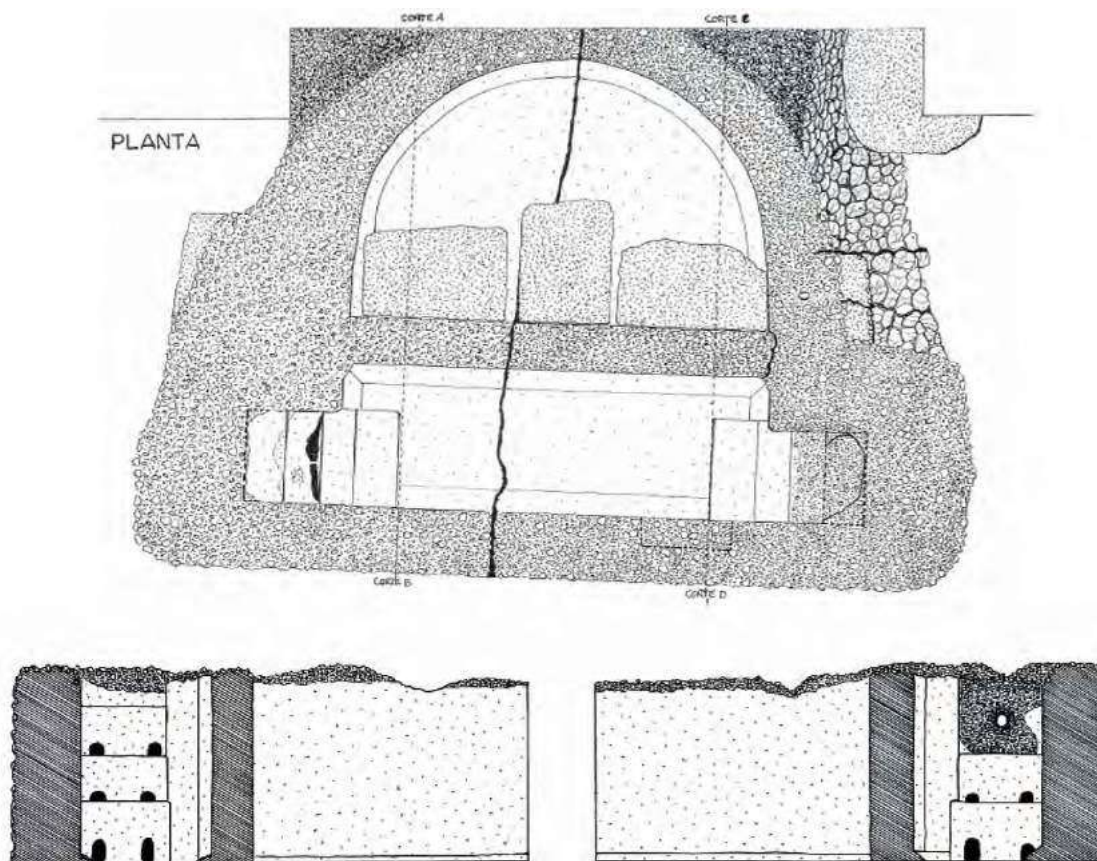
Planta del posible baptisterio (PIZARRO, 2014: 101).
